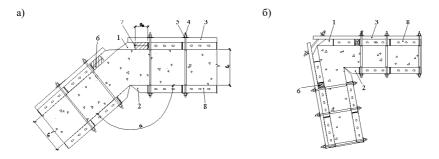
Схема устройства опалубки примыкания стен:
